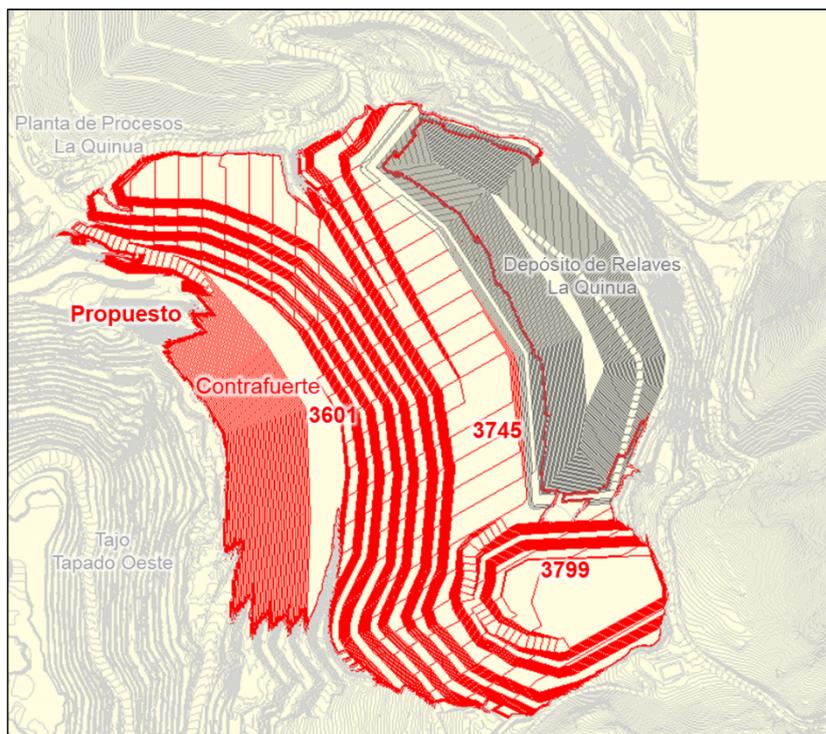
Plan de descarga del Relleno La Quinua propuesto – Año 2037 – Vista en planta
